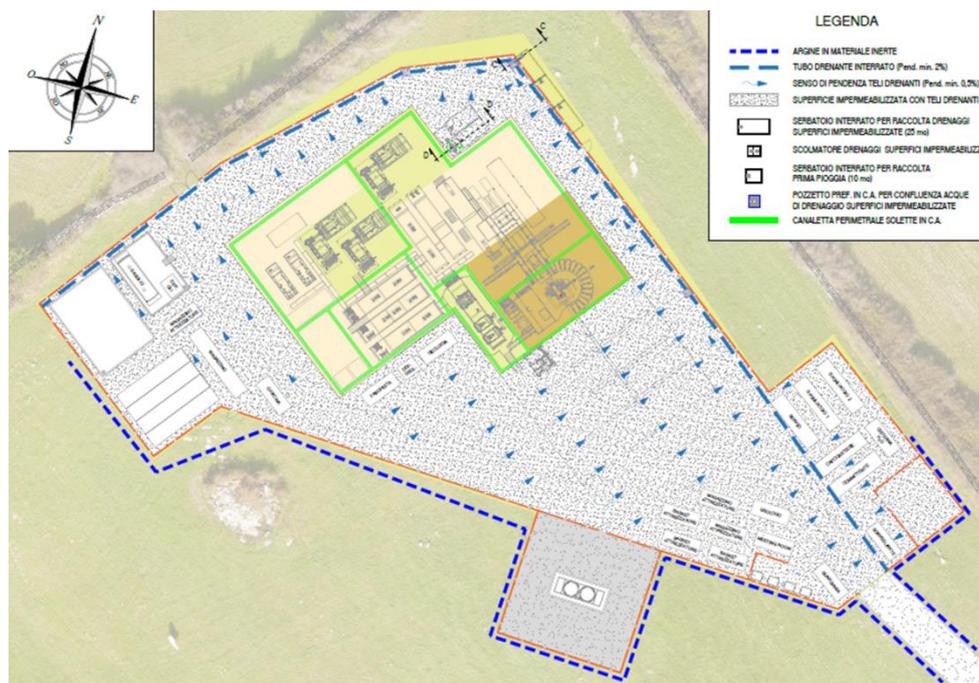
Planimetria del sistema di drenaggio ed impermeabilizzazione
